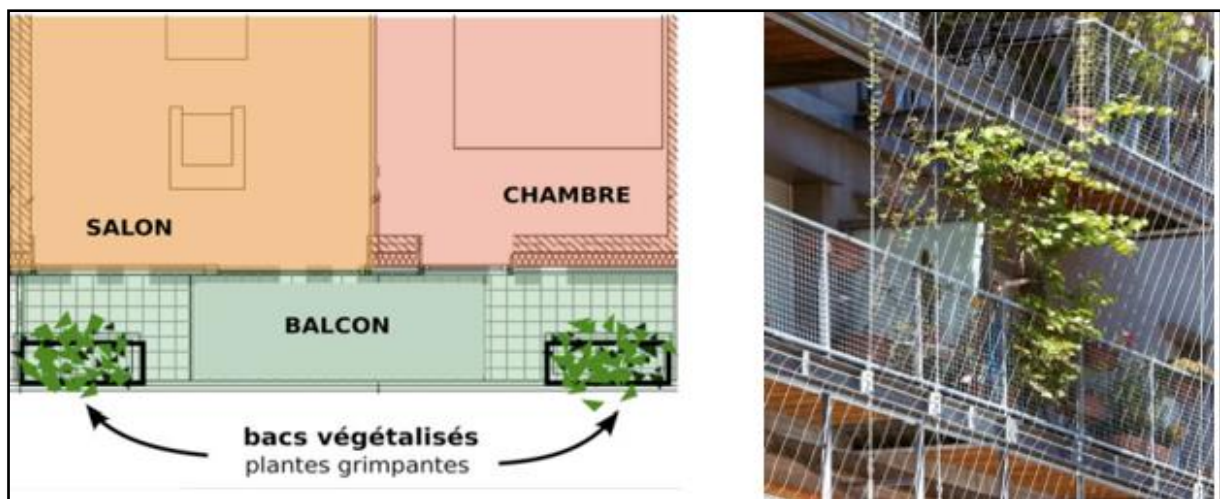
, Situation de la façade végétalisée sur les balcons du bâtiment. *Source:* (Renaud., 2012)
